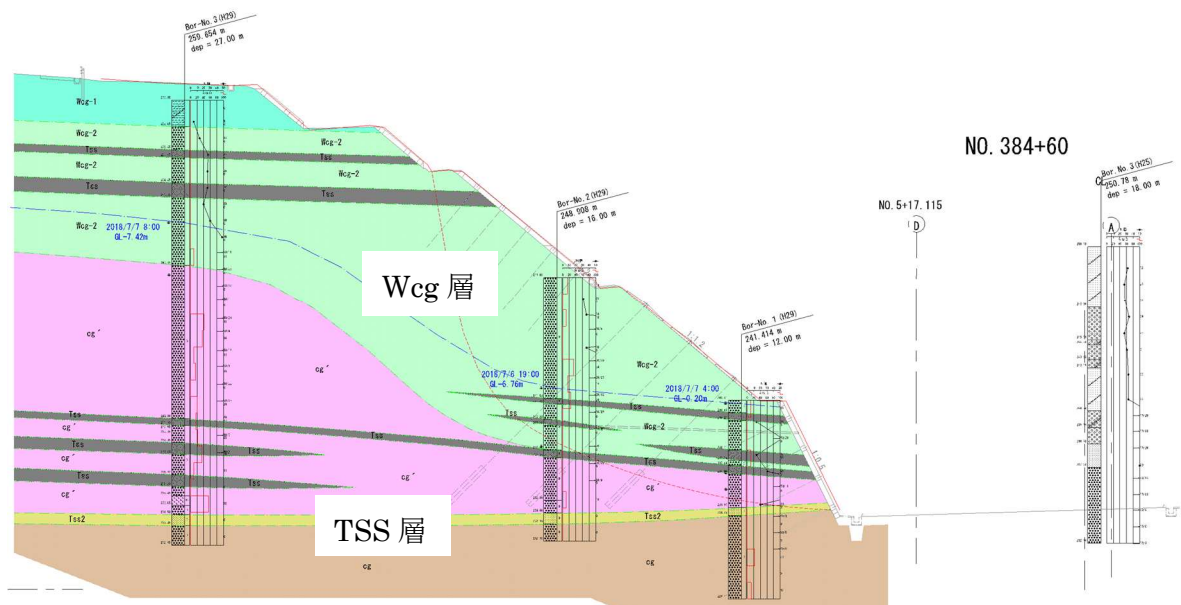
地層断面図 (No. 364+60 : ボーリング調査追加)
